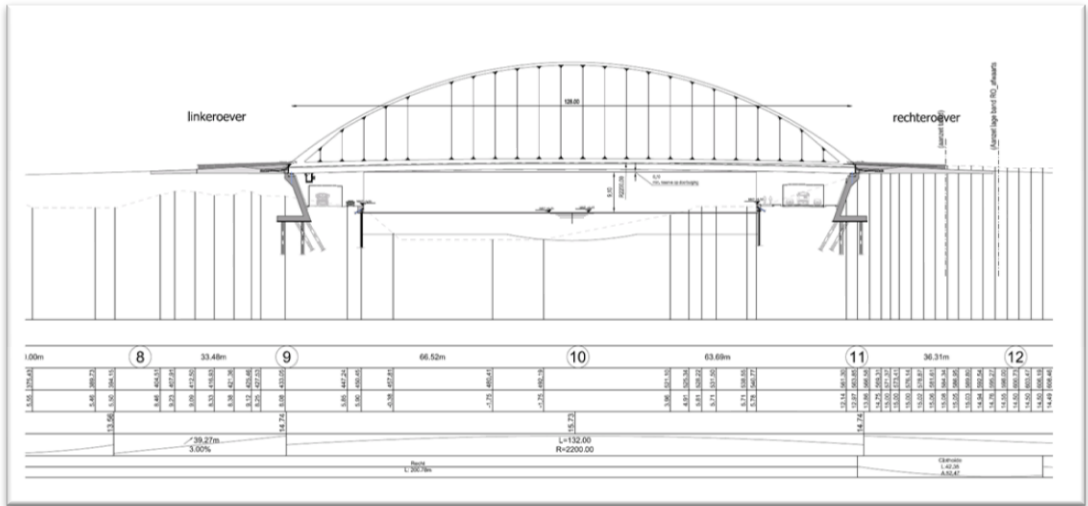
Uitsneden inplantingtekening zone 1 (noordwestelijke deel plangebied)
